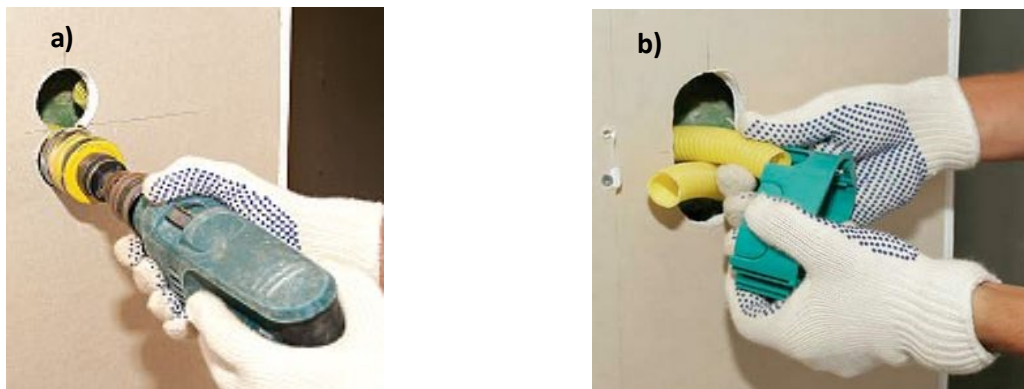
a) Perfuração das placas de gesso cartonado [44] ; b) Colocação das caixas elétricas [44].
